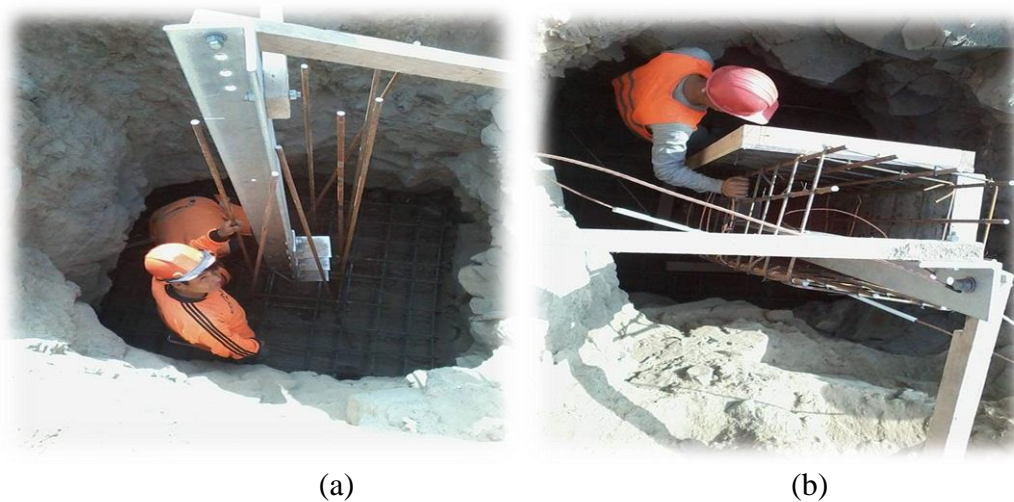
(a), (b).- Acero y encofrado para zapatas de torres
